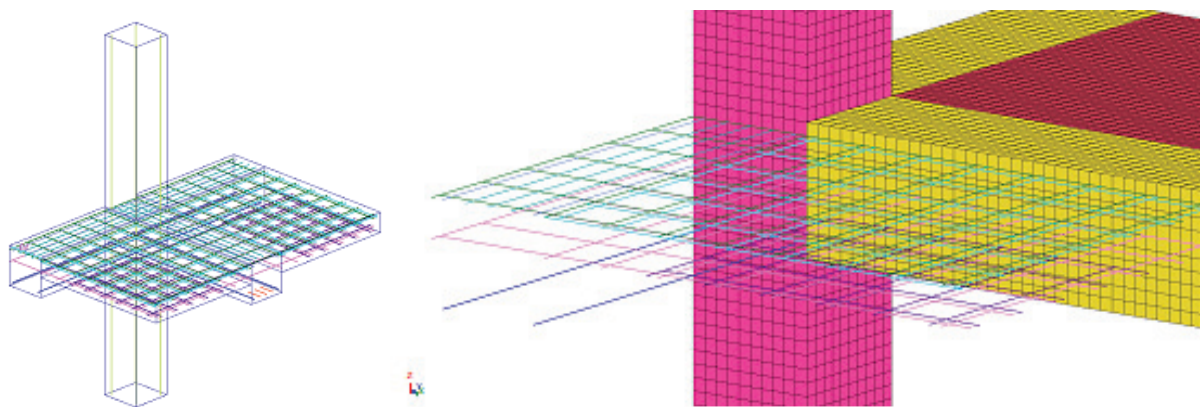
Армирование узла сопряжения колонны, балки и плиты ребристой плиты перекрытия в расчетной модели
